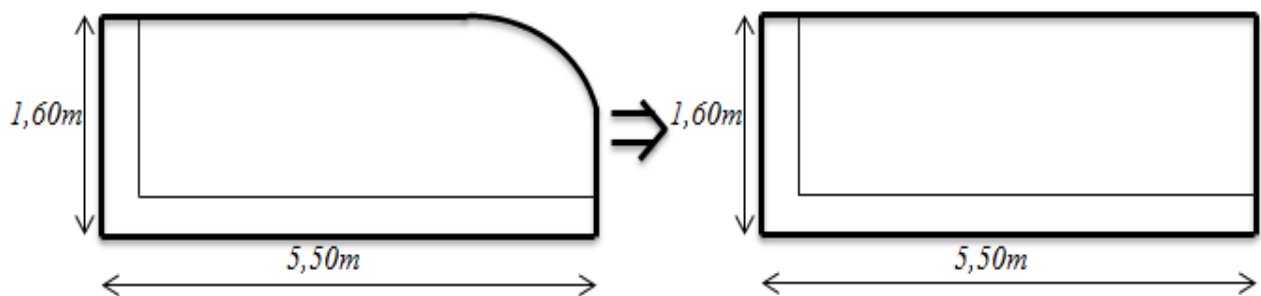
Dalle pleine sur trois (02) appuis.
